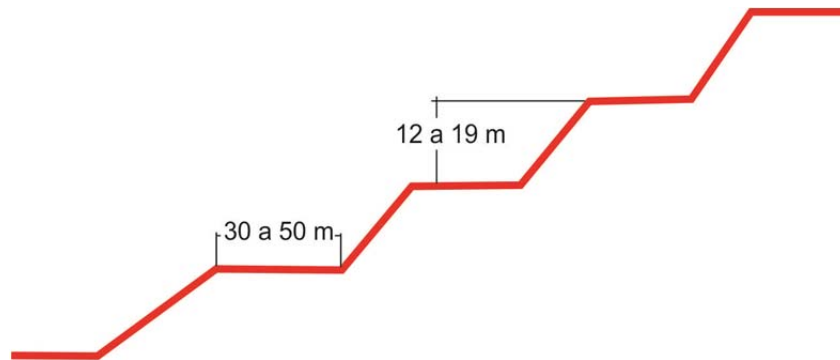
Perfil esquemático da configuração final nas bancadas.
